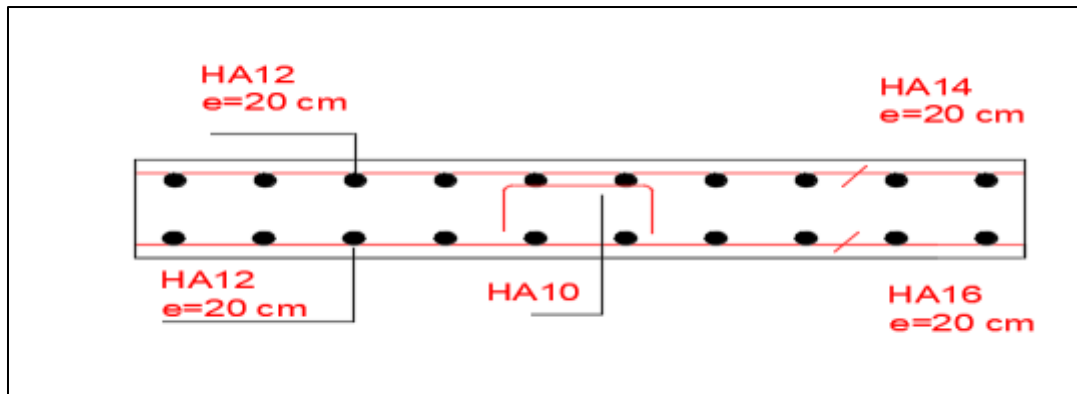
Ferrailage de la dalle (coupe transversale)
